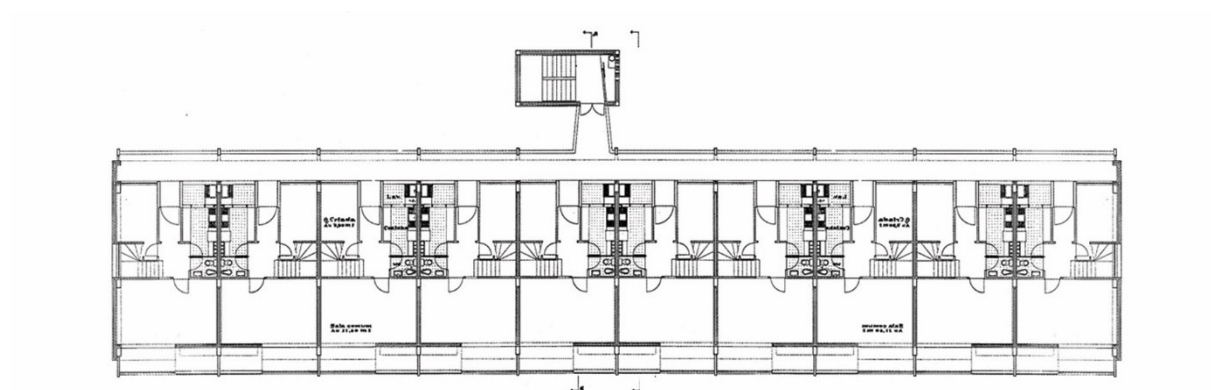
Planta do piso de entrada dos duplexes (1:500).
